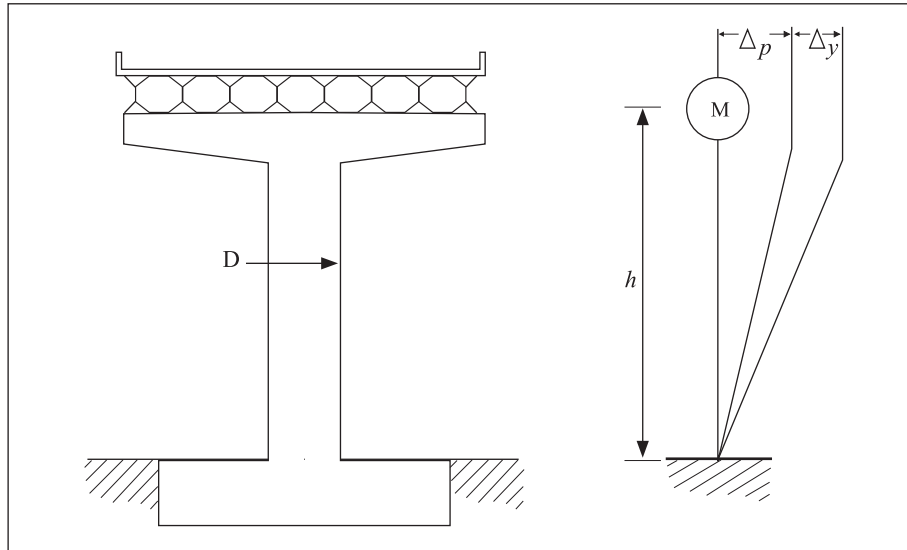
Pilar de puente Cantilever. a) Elevación transversal. b) Modelo estructural. [FUENTE: propia].
